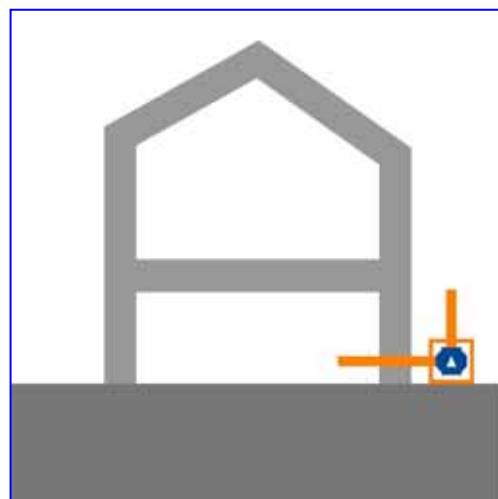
prevenzione nuova edificazione ventilazione naturale o meccanica tramite pozzetto centrale e membrana impermeabile
